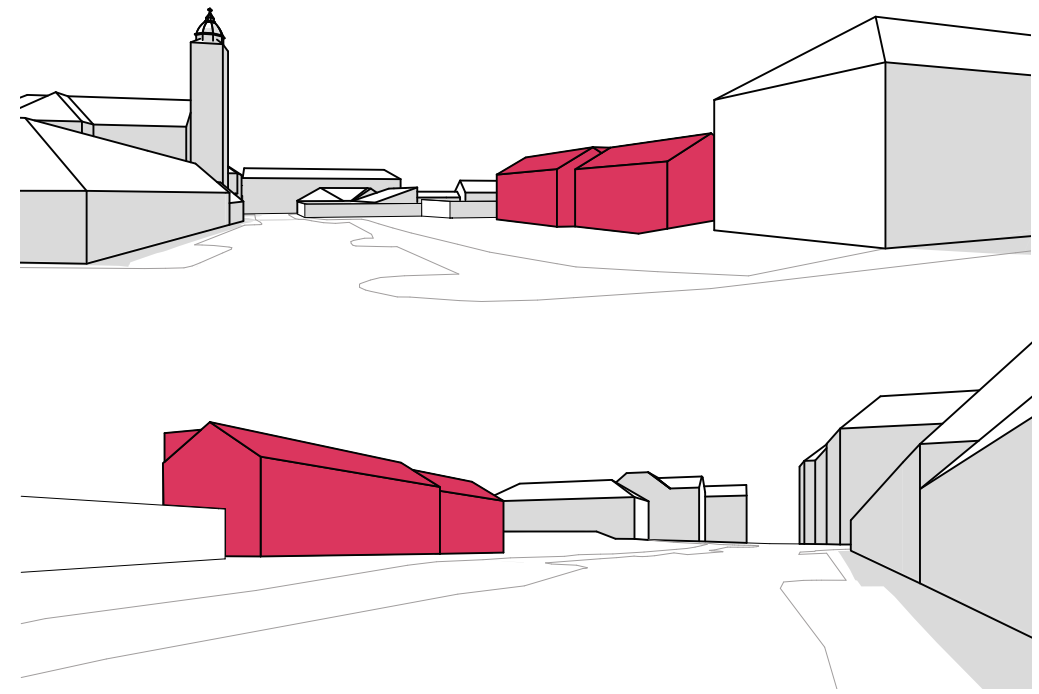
Perspektive Blick Richtung Pfarrkirche: Bebauungsvorschlag in-mitten
